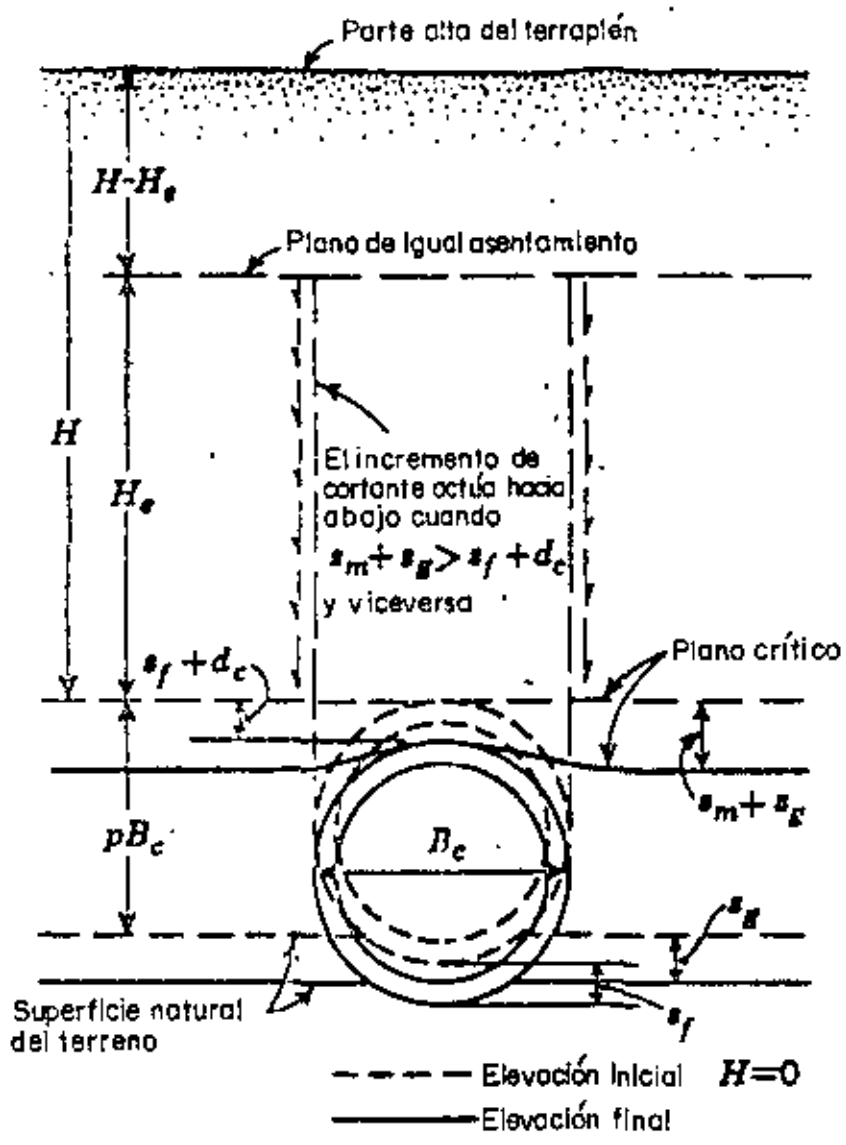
ASENTAMIENTOS QUE INFLUYEN EN LAS CARGAS DE CONDUCTOS CON PROYECCION POSITIVA.
